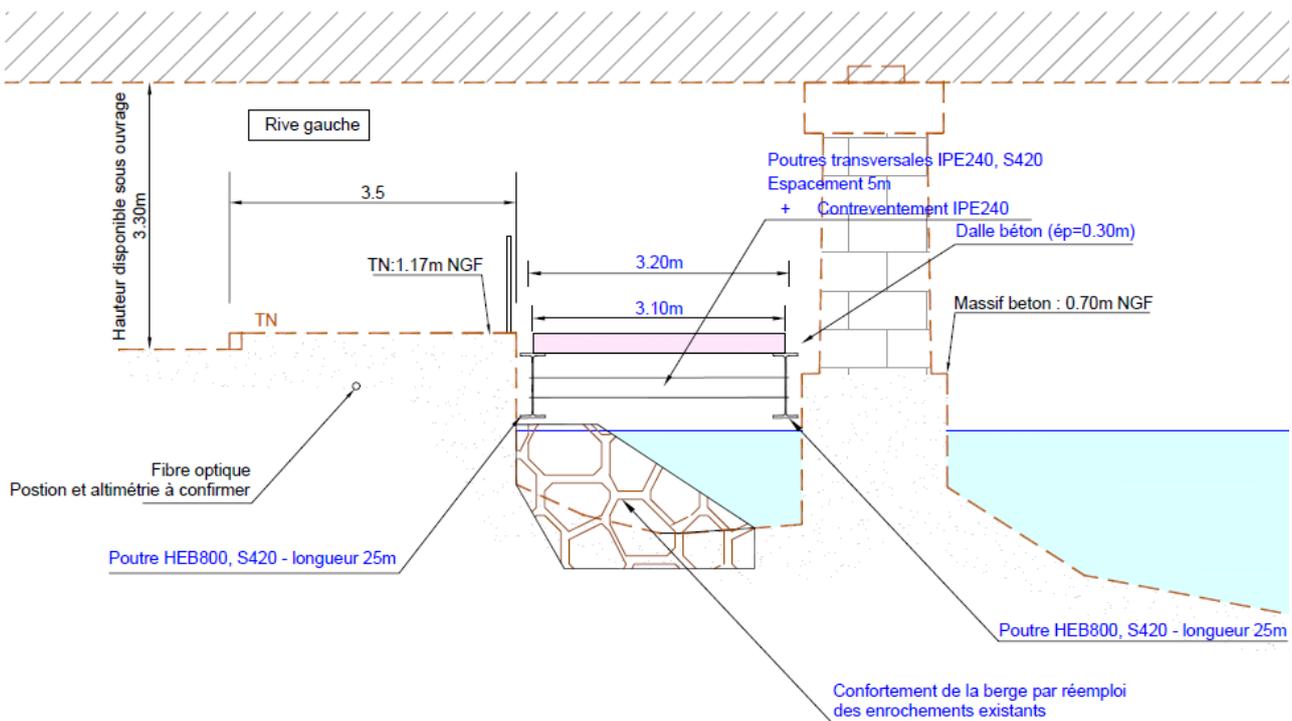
COUPE TYPE DE LA SOLUTION AU DROIT DU VIADUC SNCF
